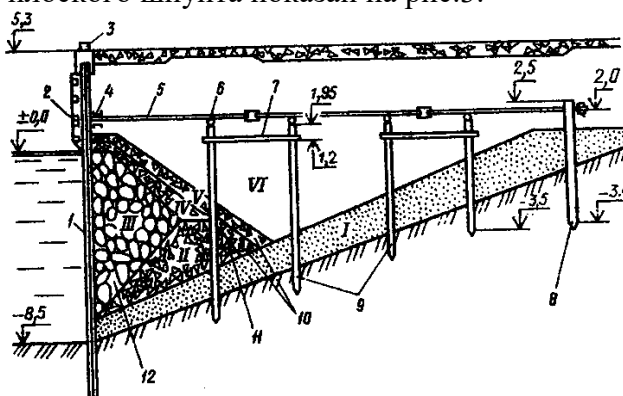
Причал типа больверка с защитной стенкой из плоского железобетонного шпунта:
